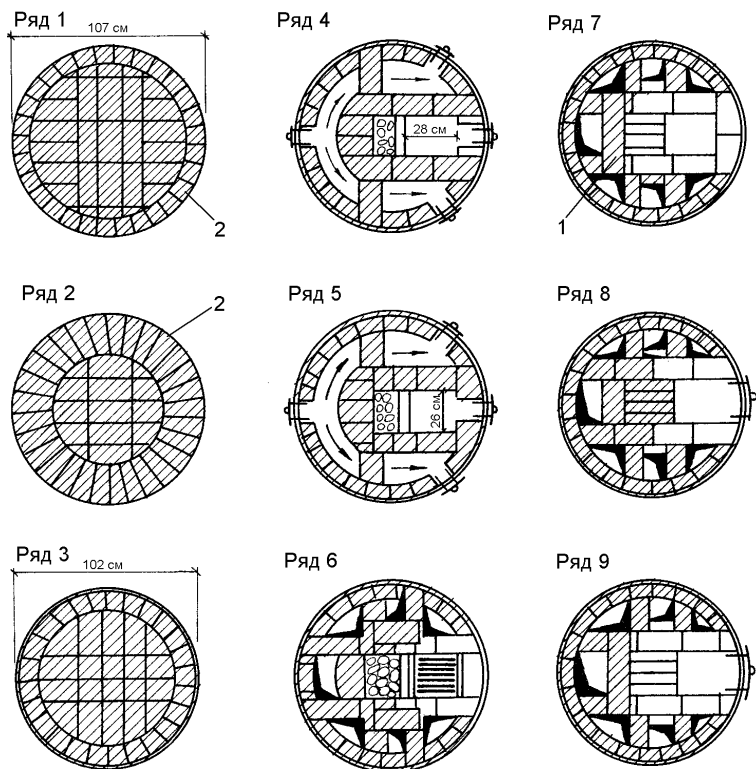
Кладка отопительной круглой печи в металлическом футляре
